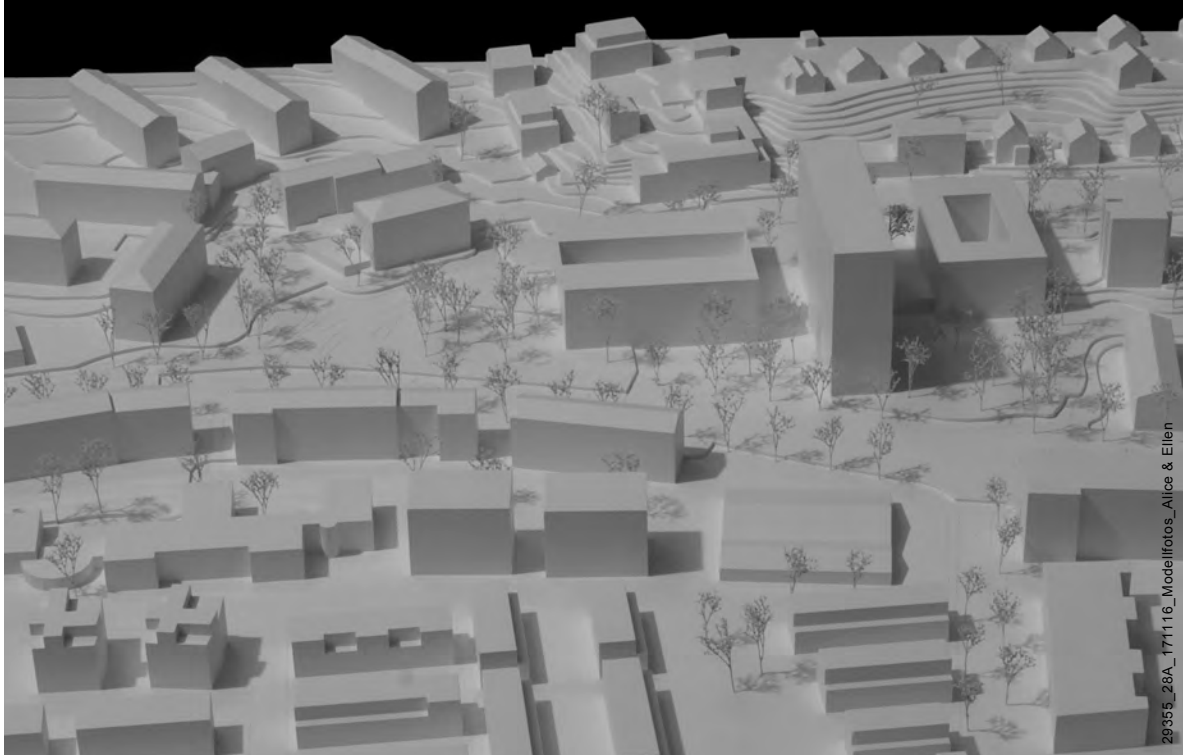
Alice &amp; Ellen: Modellfoto Nordansicht
